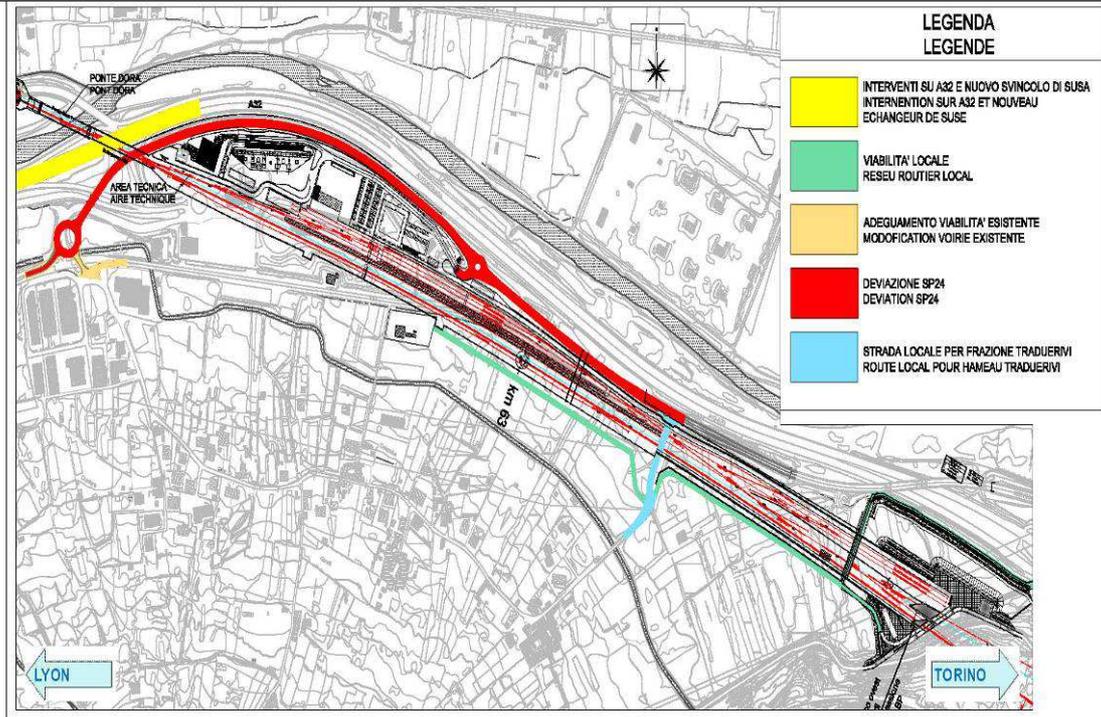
Planimetria viabilità zona area tecnica di Susa
